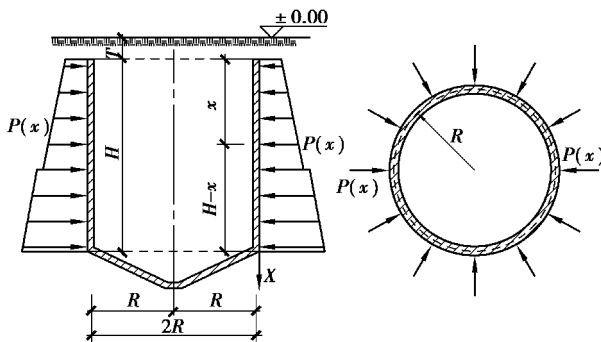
地下大直径钢筋混凝土筒仓空仓受力示意图
